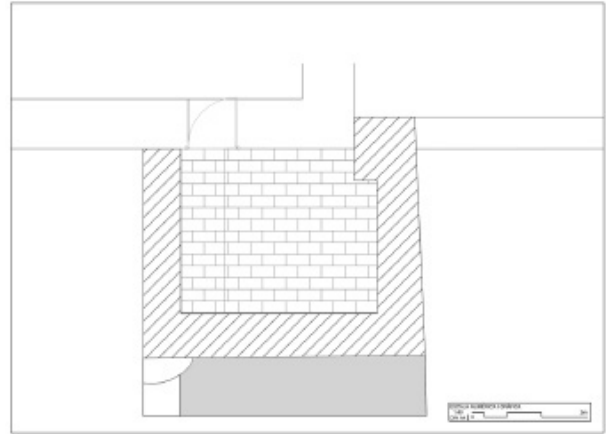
Planta de la torre amb el paviment existent abans d'iniciar l'excavació. En gris la superfície de la rasa oberta davant el mur de migdia.
